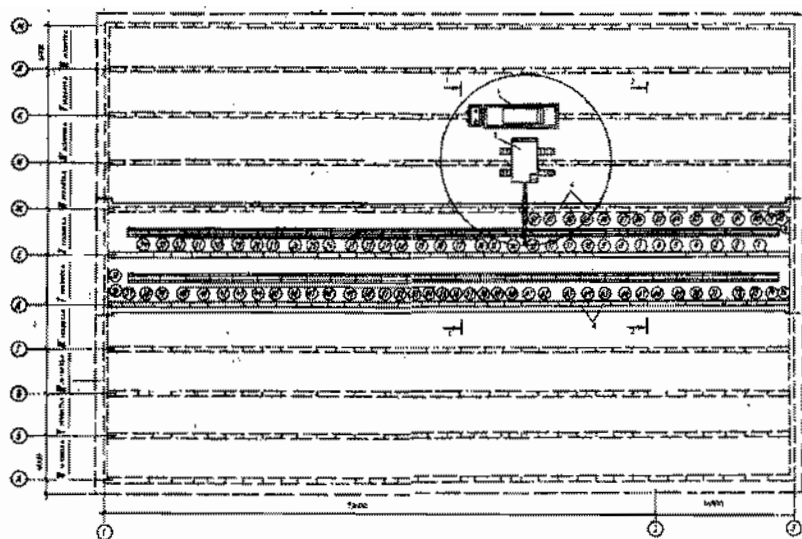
Схема организации монтажа горизонтального отстойника гусеничным краном: 1 - панелевоз; 2 - временная дорога из сборных железобетонных плит; 3 - монтажный гусеничный кран МКГ-25; 4 - стеновые панели коридоров; 5 - опалубка труб для отвода осадка; 6 - монолитное днище; 7 - бетонная подготовка; 8 - опалубка монолитного железобетонного пояса
